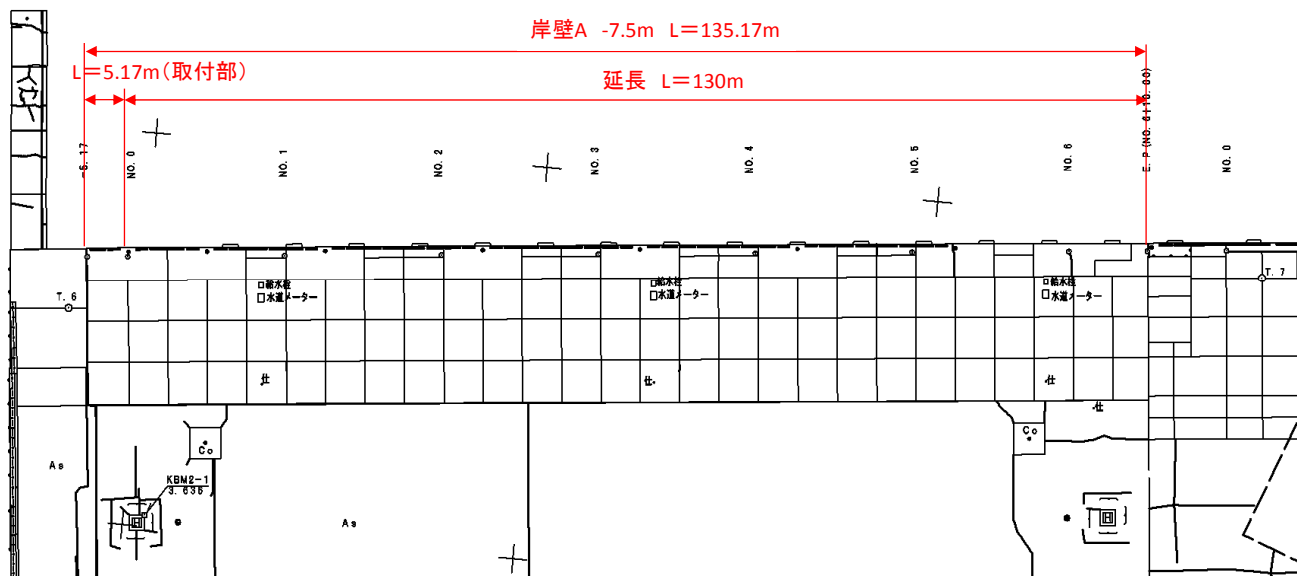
No.20 常陸那珂港区\_中央ふ頭地区岸壁 (-7.5m) の平面図 (被災前)
